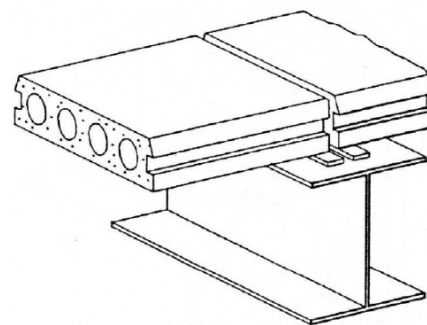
Ligação de lajes alveolares simplesmente apoiadas sobre neoprene, em uma viga metálica “I” (PCI,2004)
